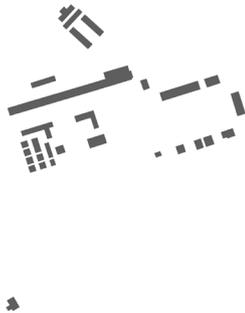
Roça Porto Alegre - Construções originais (1890), Autor
